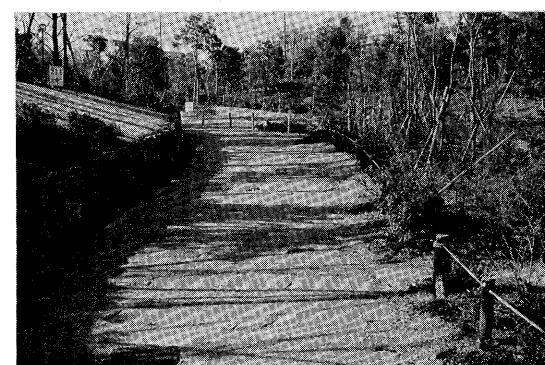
多摩ニュータウン生爪緑地のコンクリート洗い出し舗装
